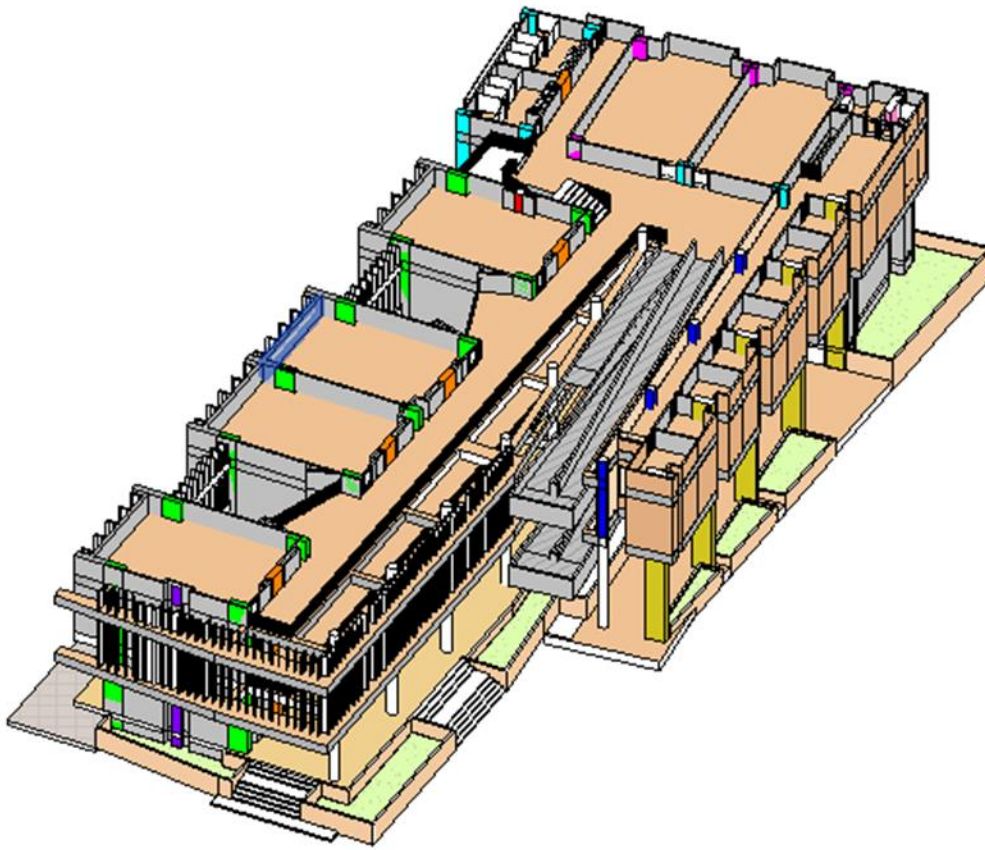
Vista Sección Arquitectónica planta N° 3.
